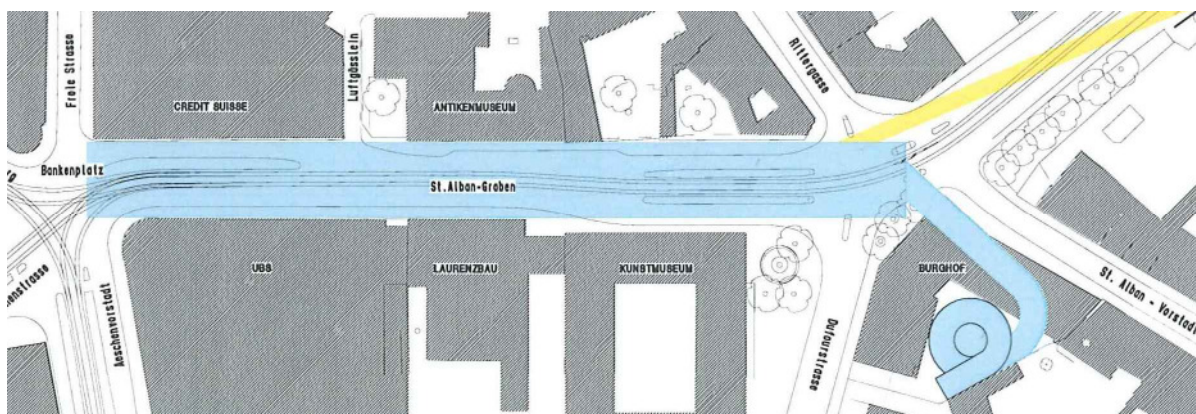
Parking «Kunstmuseum», Grundriss, Stand Planung 2008
